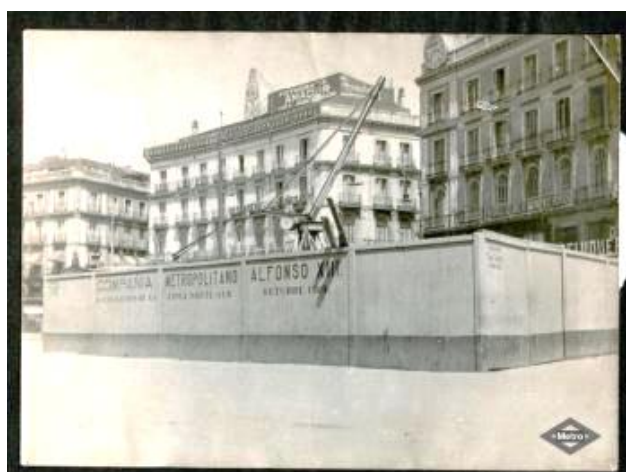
Vallado de las primeras obras del Metropolitano en la Puerta del Sol.
